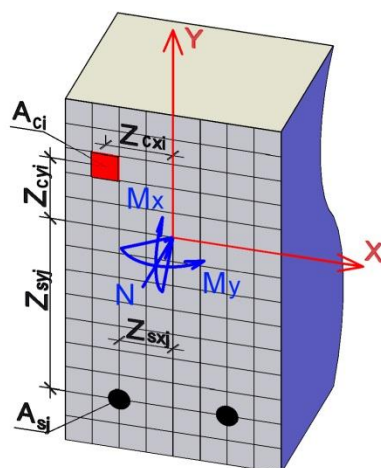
Схема разбиения поперечного сечения железобетонного элемента
